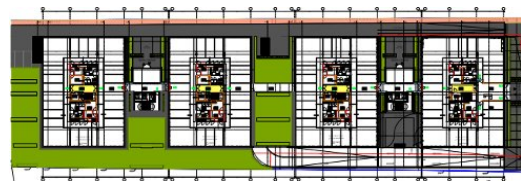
Grundriss, Etage 1 über alle vier Gebäudeblöcke
